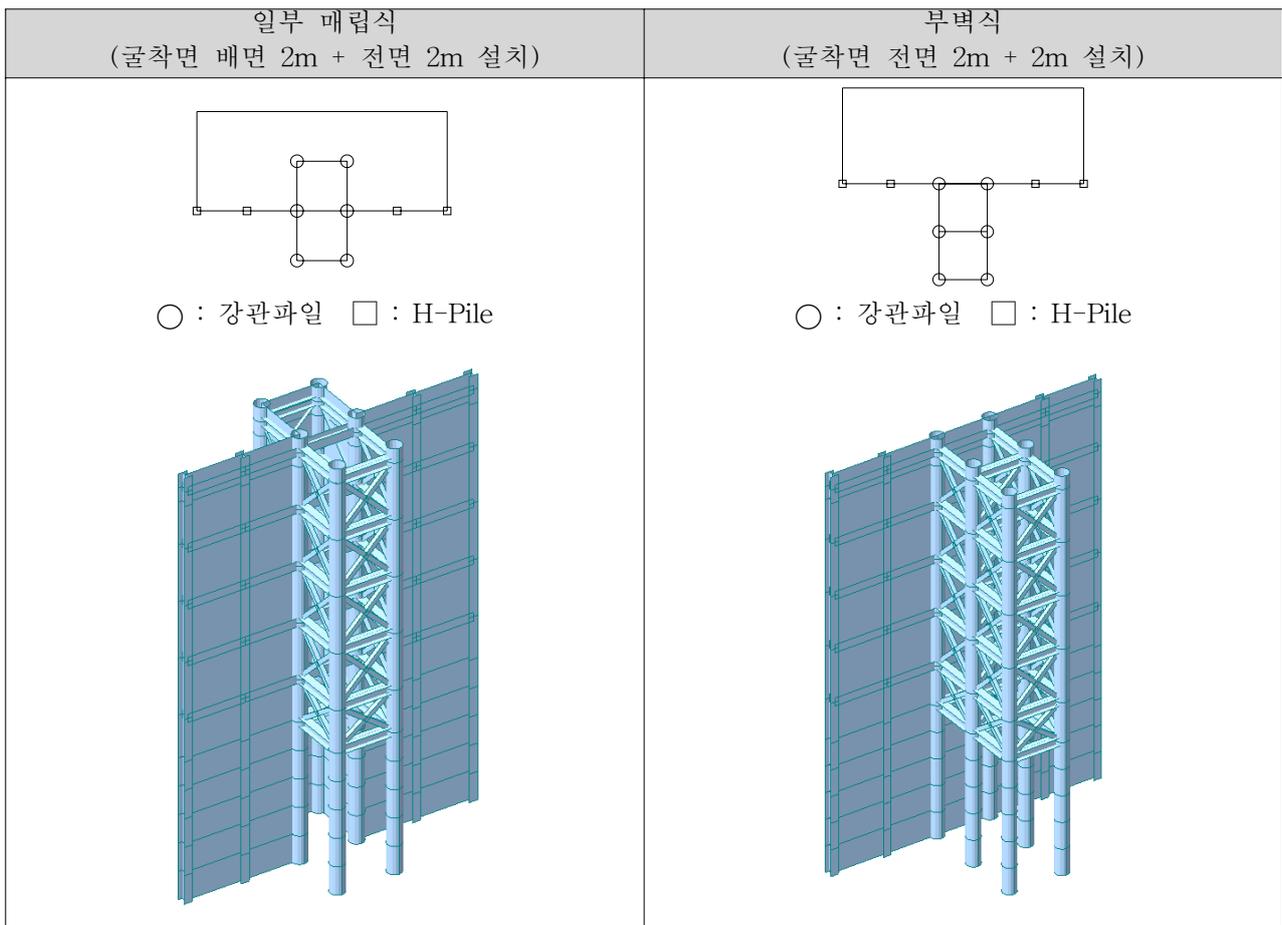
선정된 표준단면(Tower Truss System + S.C.W)
